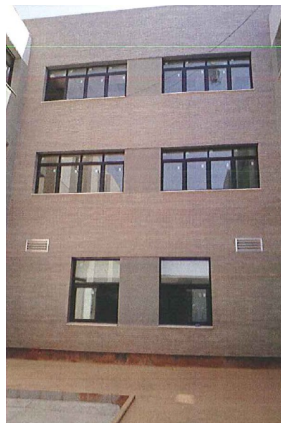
Vista general en el lugar donde ocurrió el accidente. El trabajador tenía que llegar a la segunda planta para pintar, lo que supone una altura de unos 10 metros desde el suelo.
